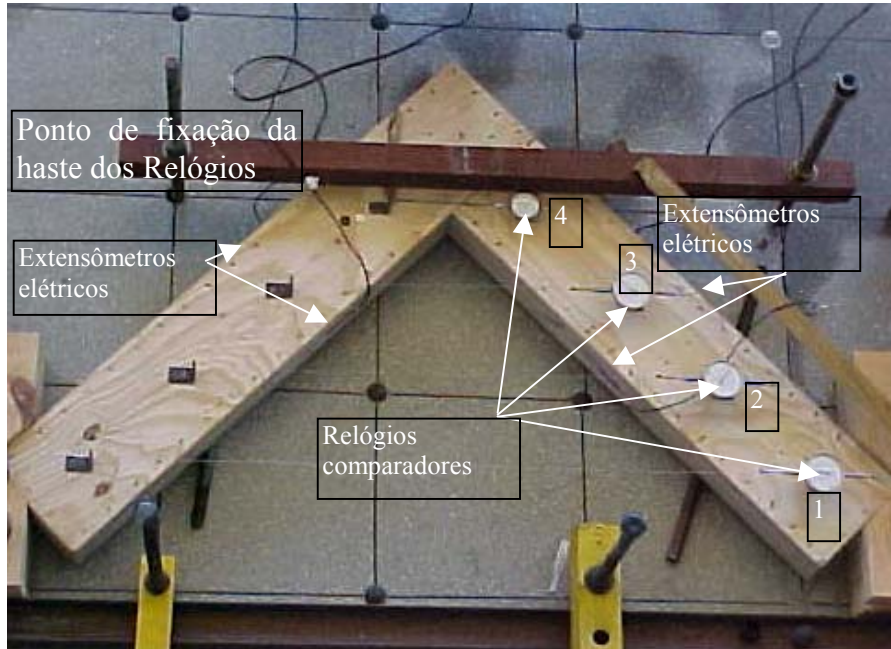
Instrumentação dos CPs de nó de pórtico.
